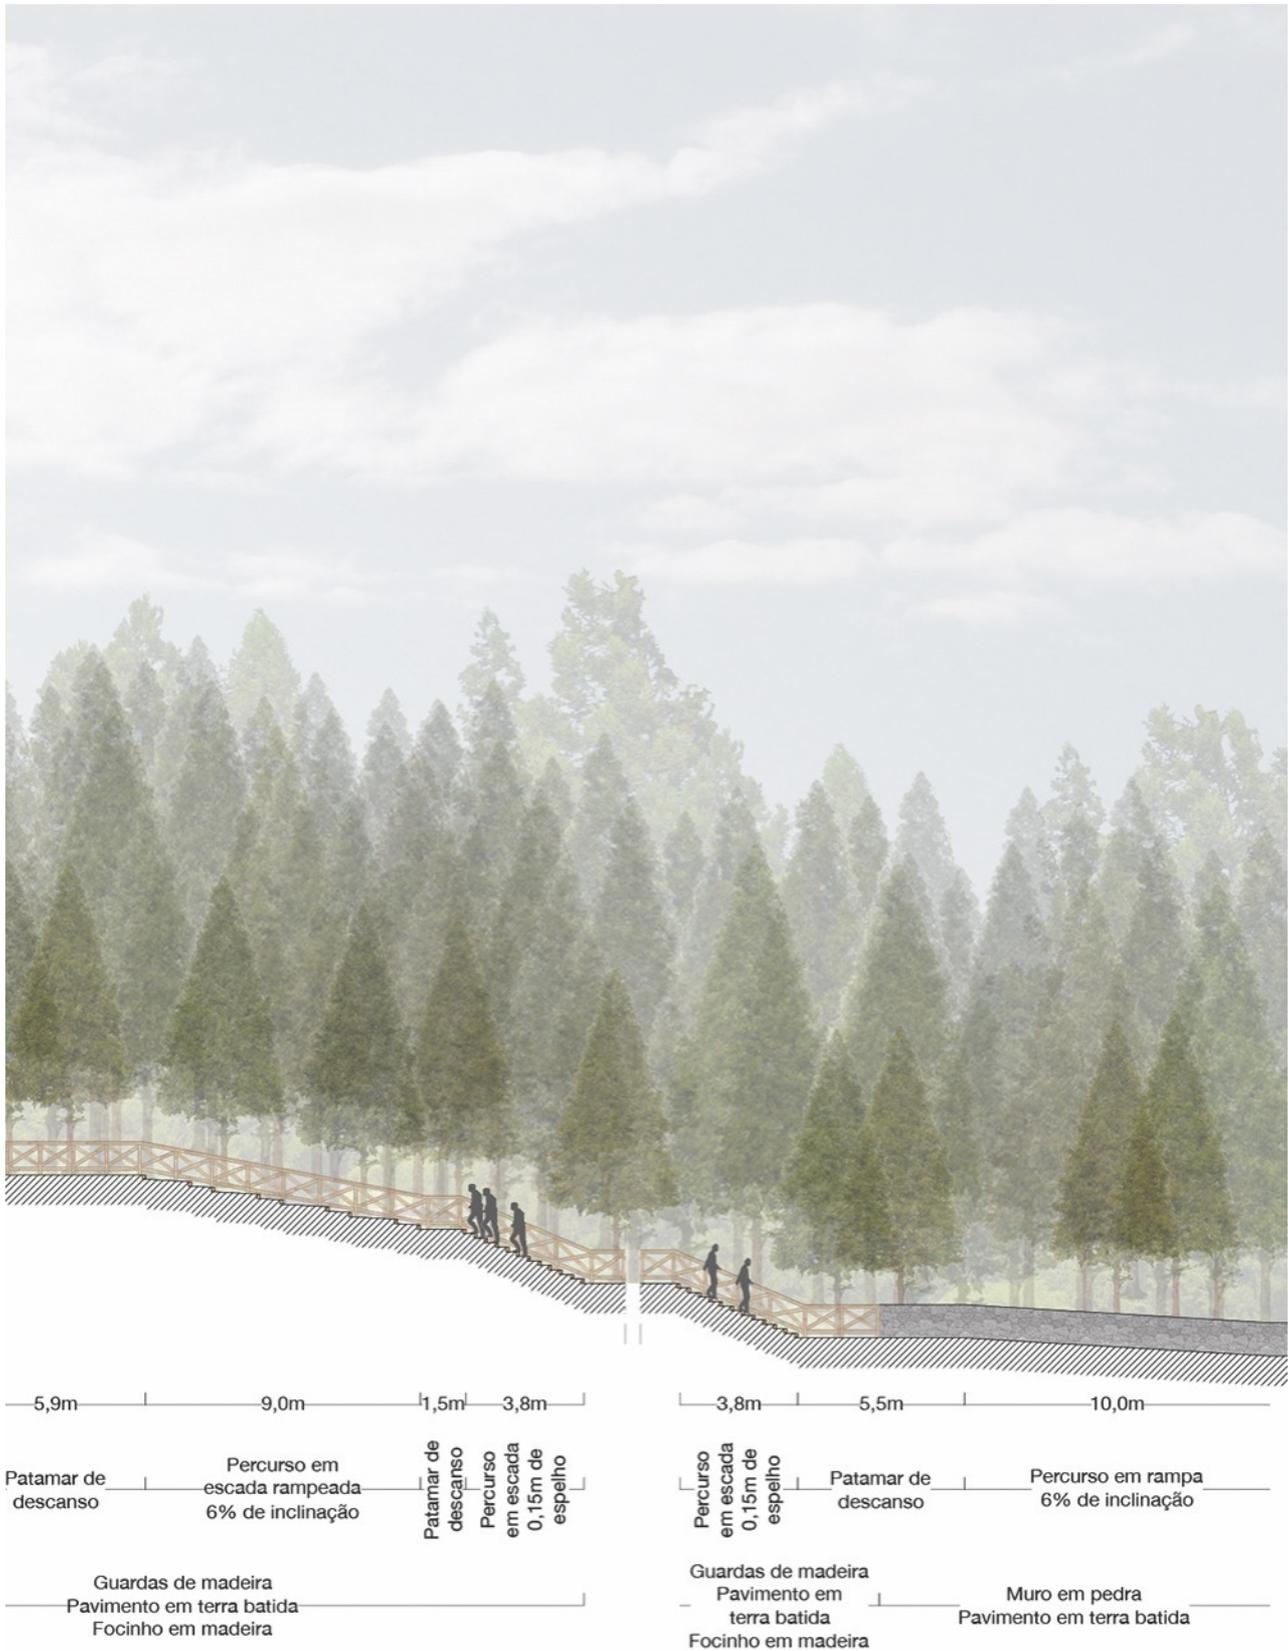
Perfil longitudinal C-C' - Troço Norte
